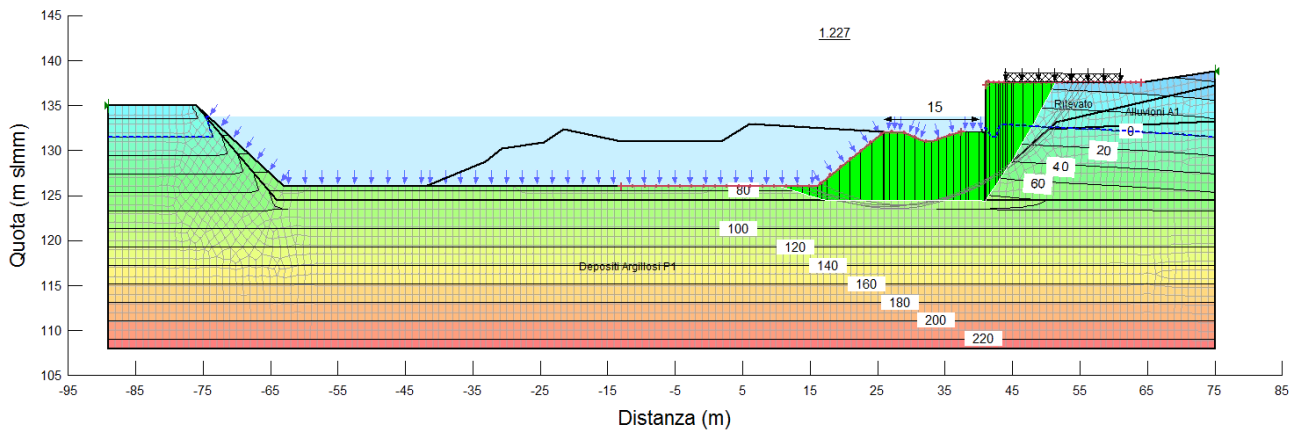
Sezione 16: Analisi di stabilità globale con scalzamento fino a 15 m a 33 h dall'inizio della piena con parametri fattorizzati
